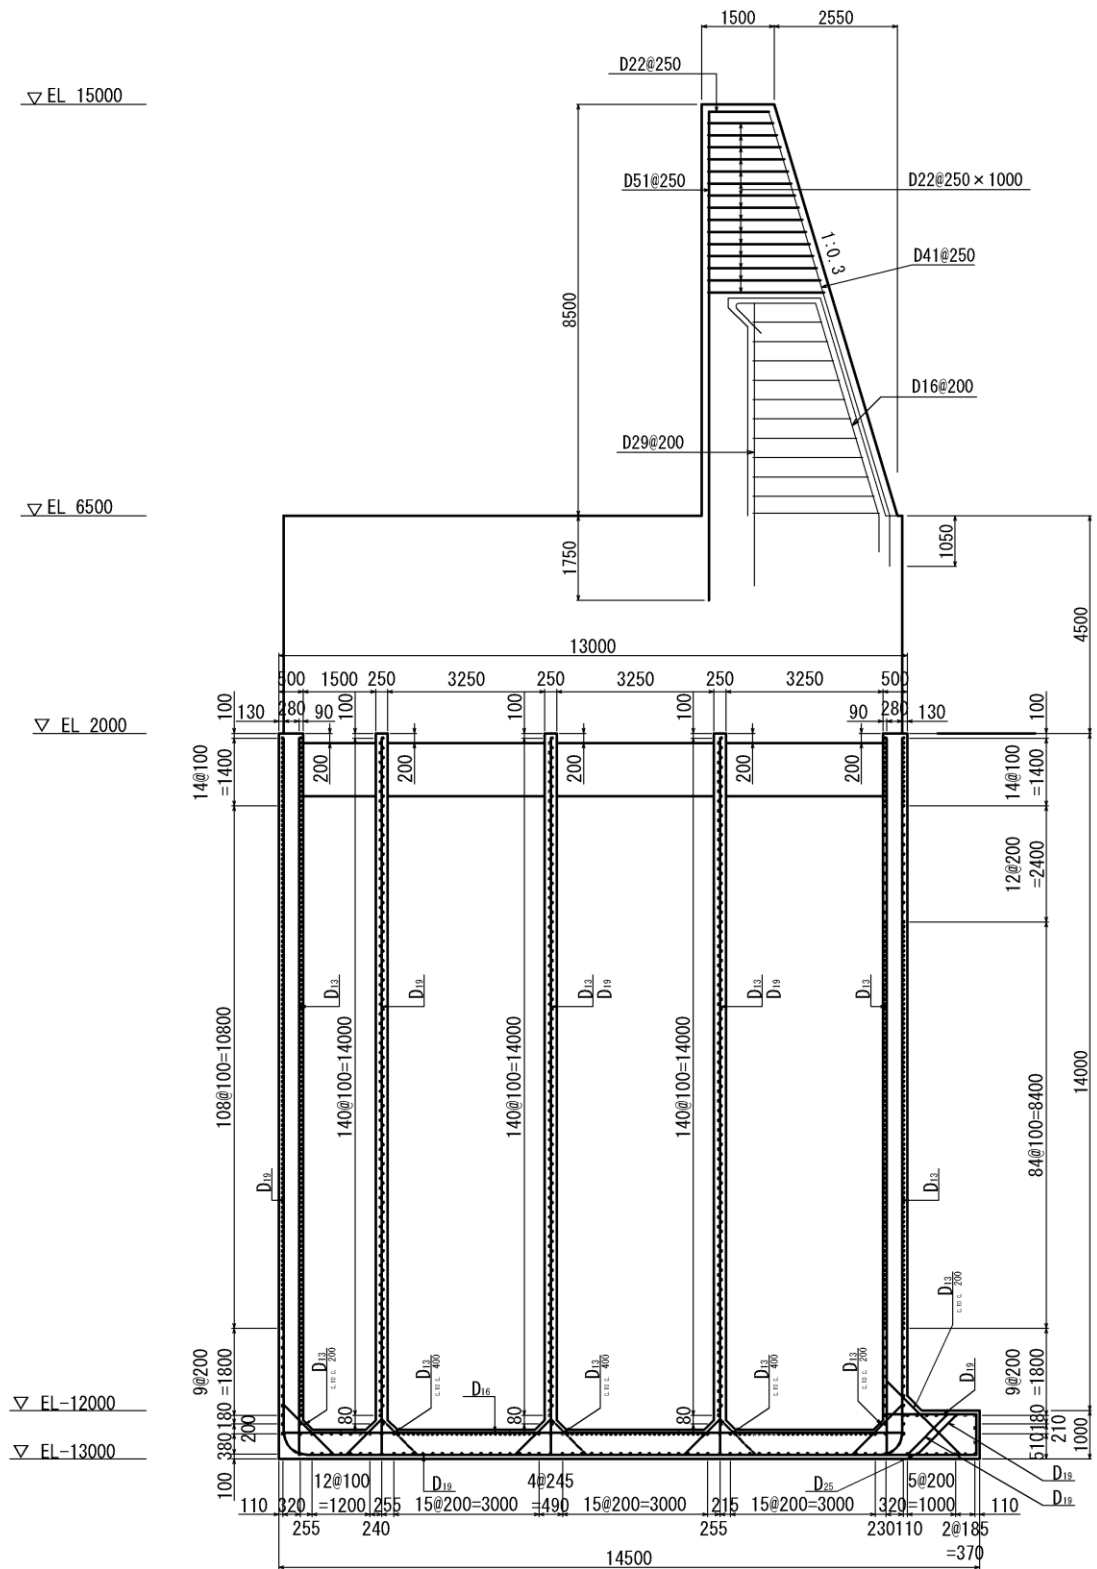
防波壁（波返重力擁壁）の概略配筋図（②-②断面）
